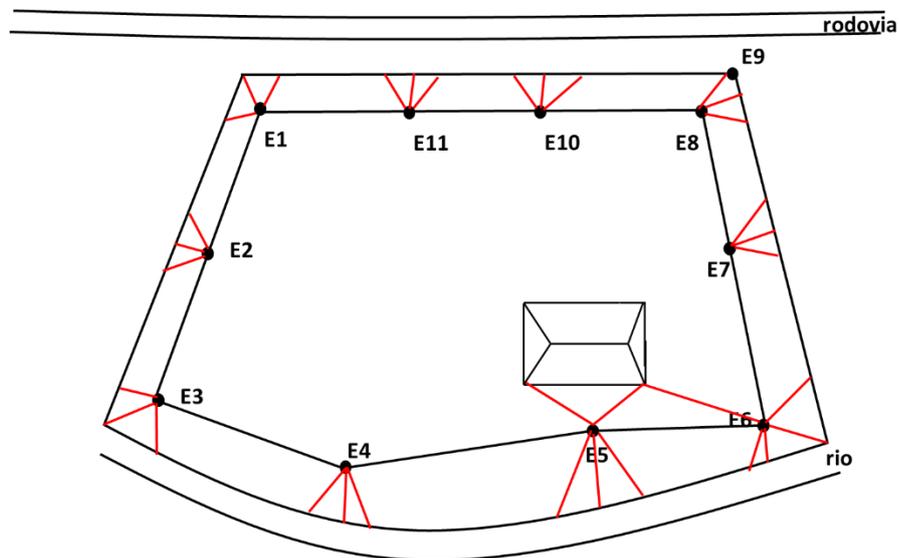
Levantamento por caminhamento: poligonal base, perímetro levantado e pontos de detalhe.
